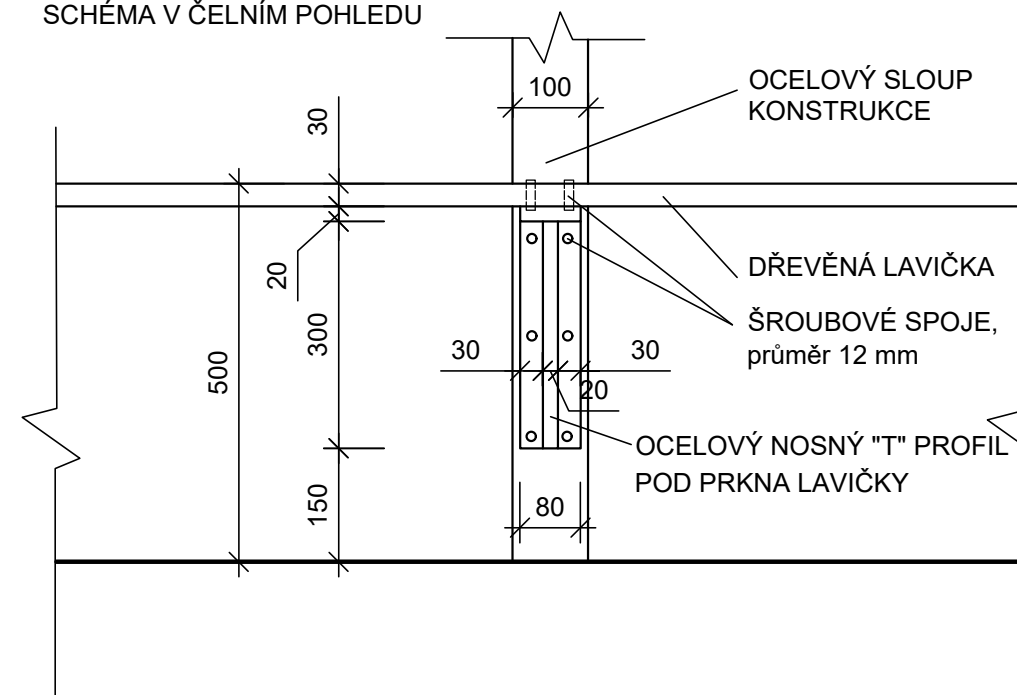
DETAIL C - UPEVNĚNÍ DŘEVĚNÉ LAVIČKY KE SLOUPU KONSTRUKCE 1:10
